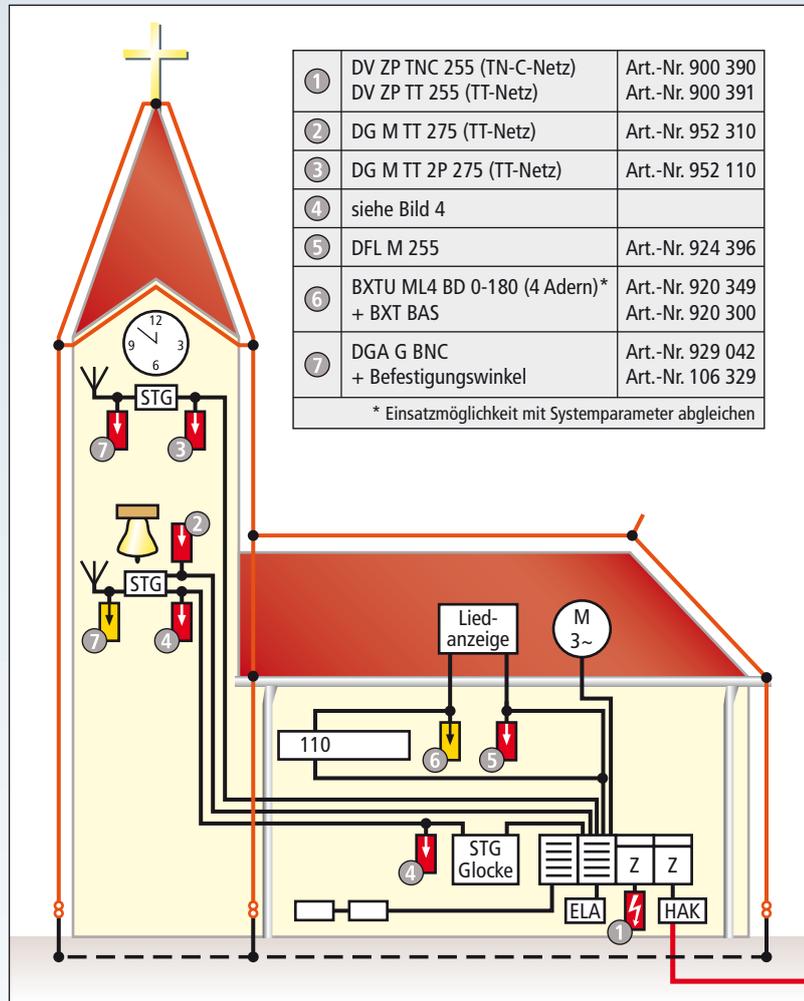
Prinzip des Äußeren und Inneren Blitzschutzes einer Kirche mit angebautem Kirchturm
